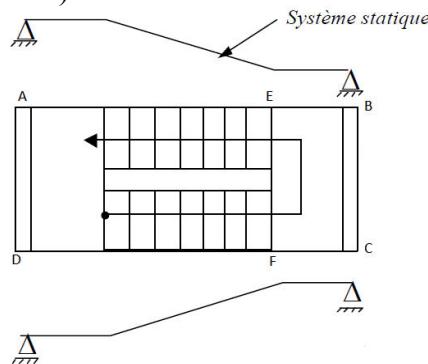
Schémas de calcul d'escaliers à paillasses parallèles
